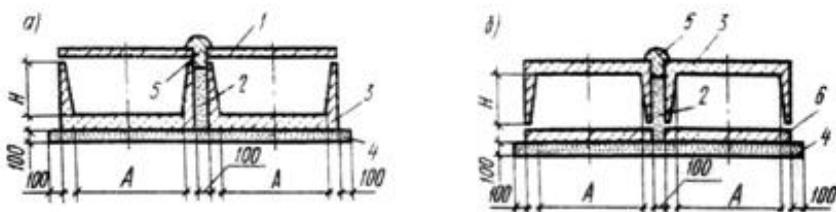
Конструкция сборного железобетонного канала из верхних (а) и нижних (б) лотковых элементов:
